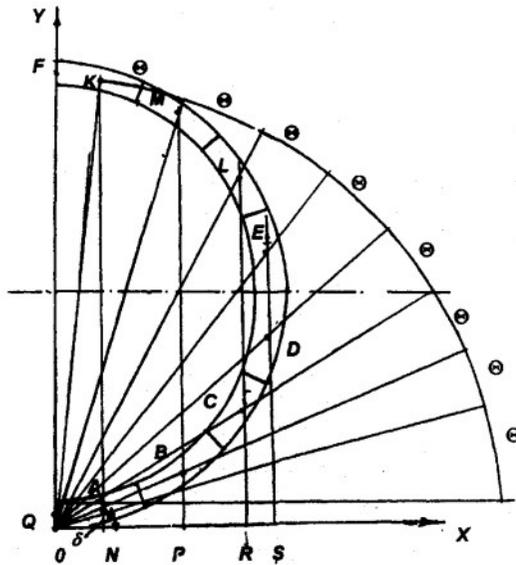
Расчетная схема при определении нагрузок вышележащих слоев бетонной смеси на нижележащие
